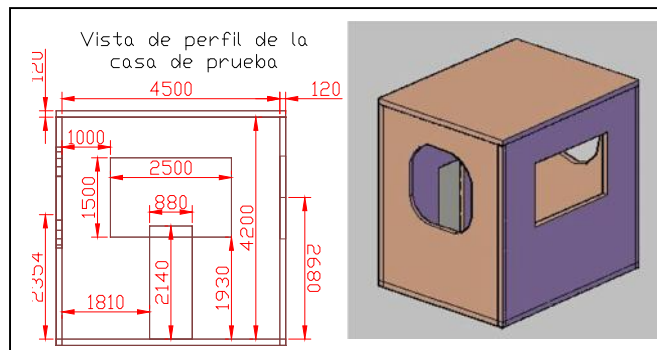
Dimensionado y geometría de la cámara de pruebas.
